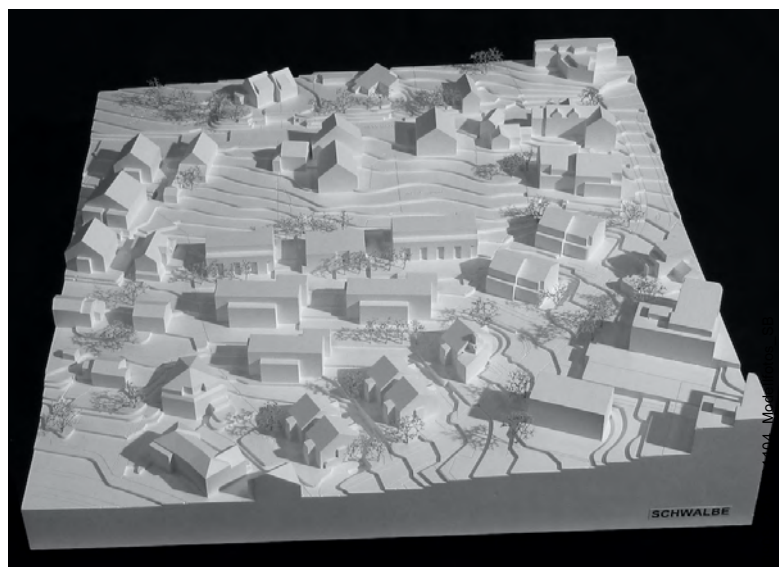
Modellfoto Projekt Kämpfen Zinke + Partner
